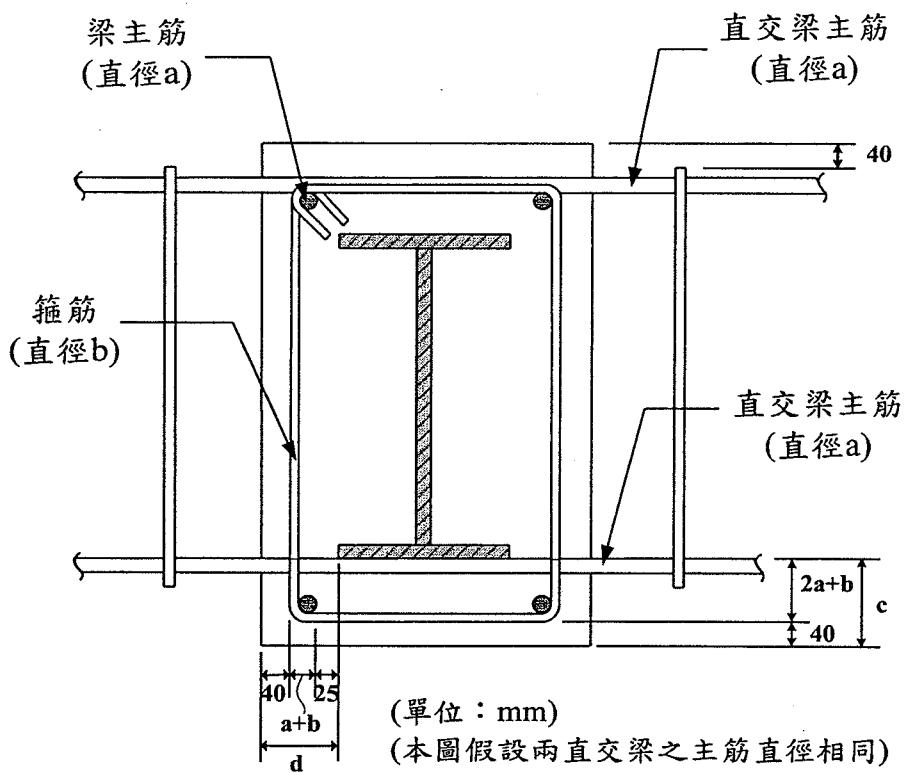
SRC 梁斷面配置細部示意圖[1]
